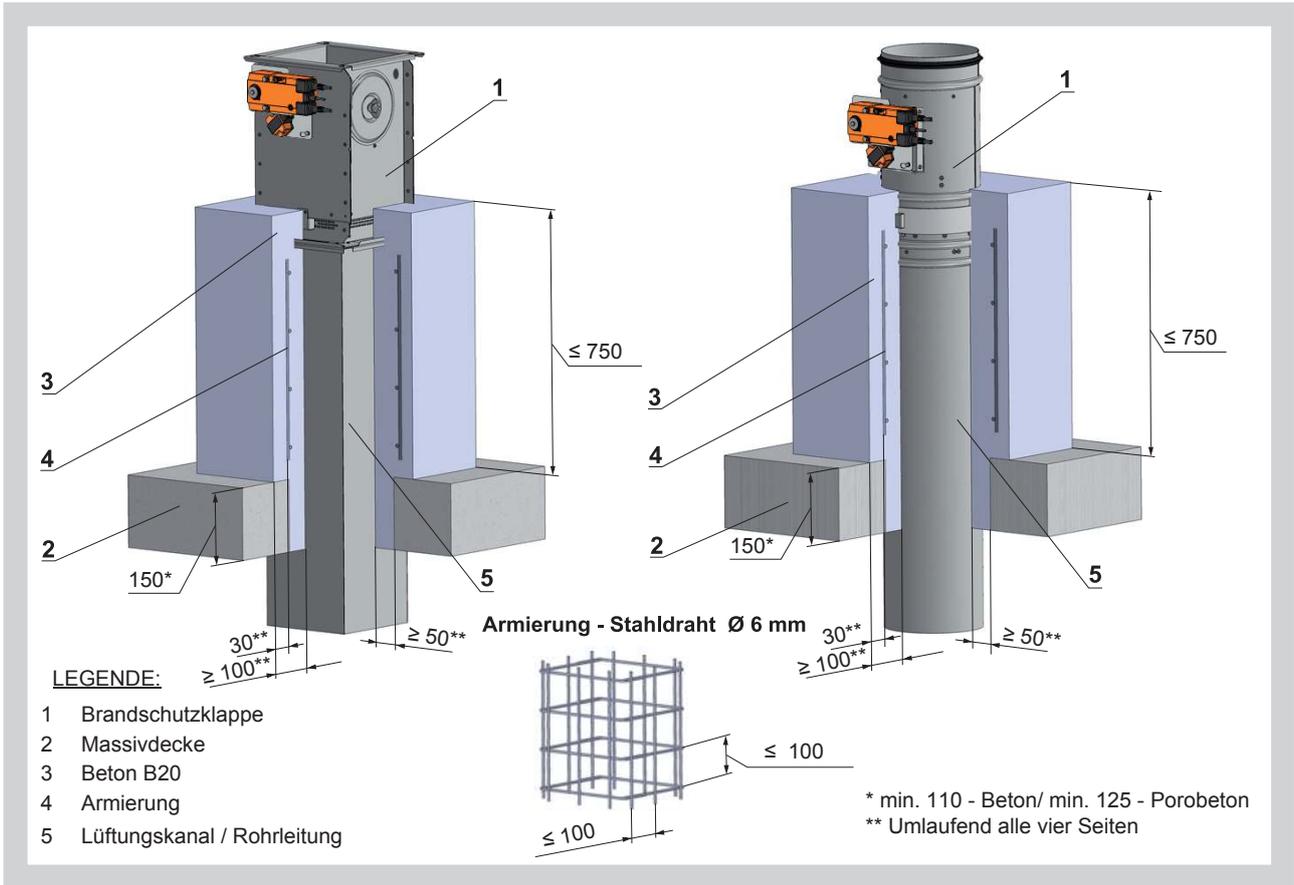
Entfernt von oder an Massivdecken - Nasseinbau - Betonmantel und Einbaurahmen
